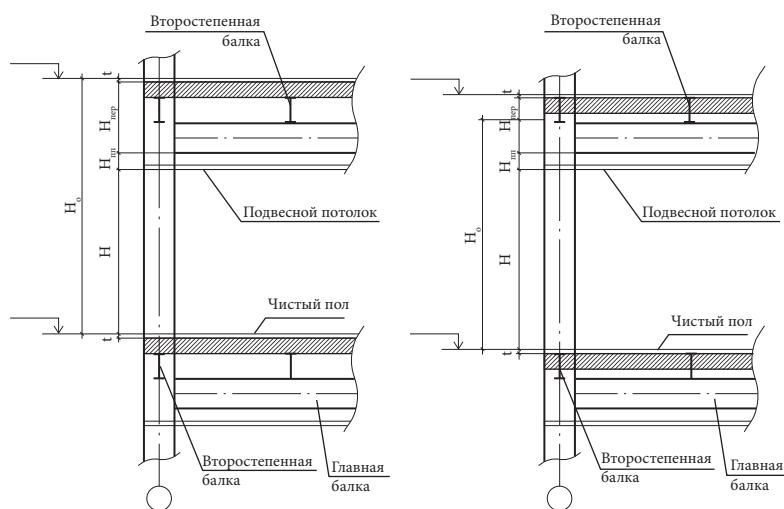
Расположение основных несущих элементов каркаса по вертикали при этажном опирании второстепенных балок
